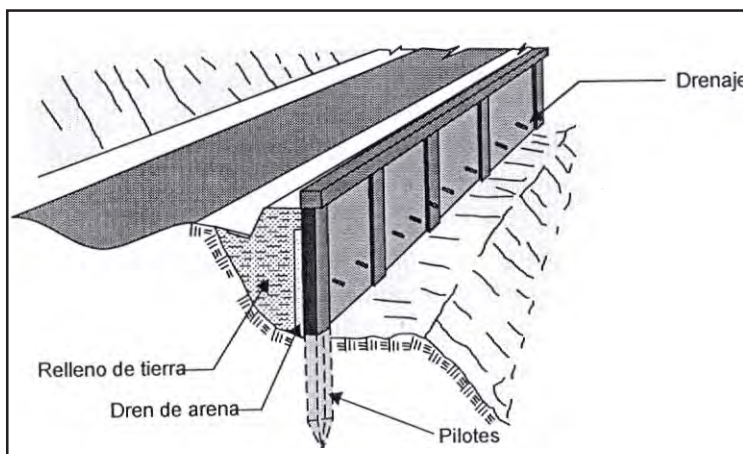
Ejemplo de muros con pilotes (tomado de Ingemmet, 2000).
